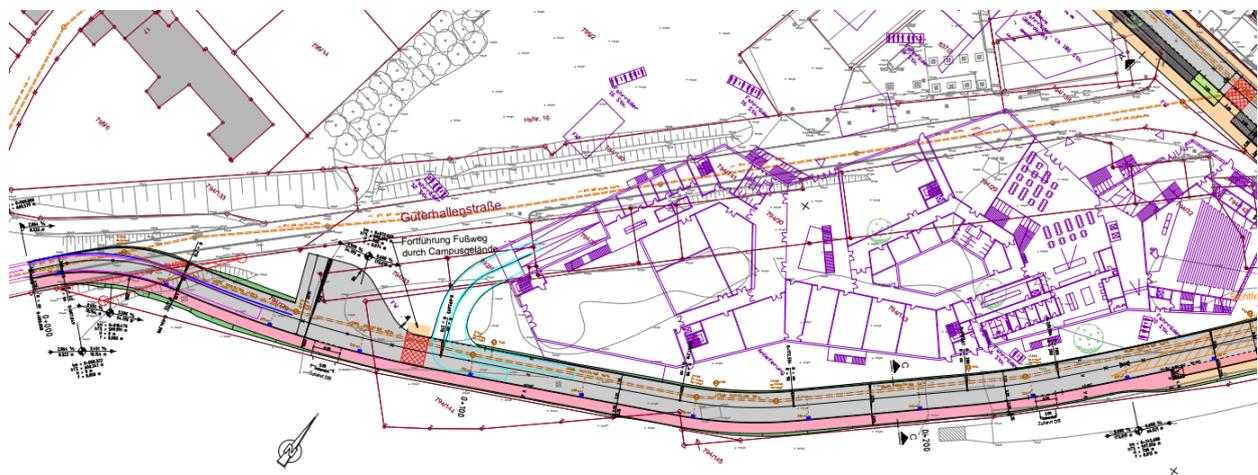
Lageplan Straßenplanung Güterhallenstraße, Stand 05.06.2023, Ingenieurbüro BPR, Traunstein
